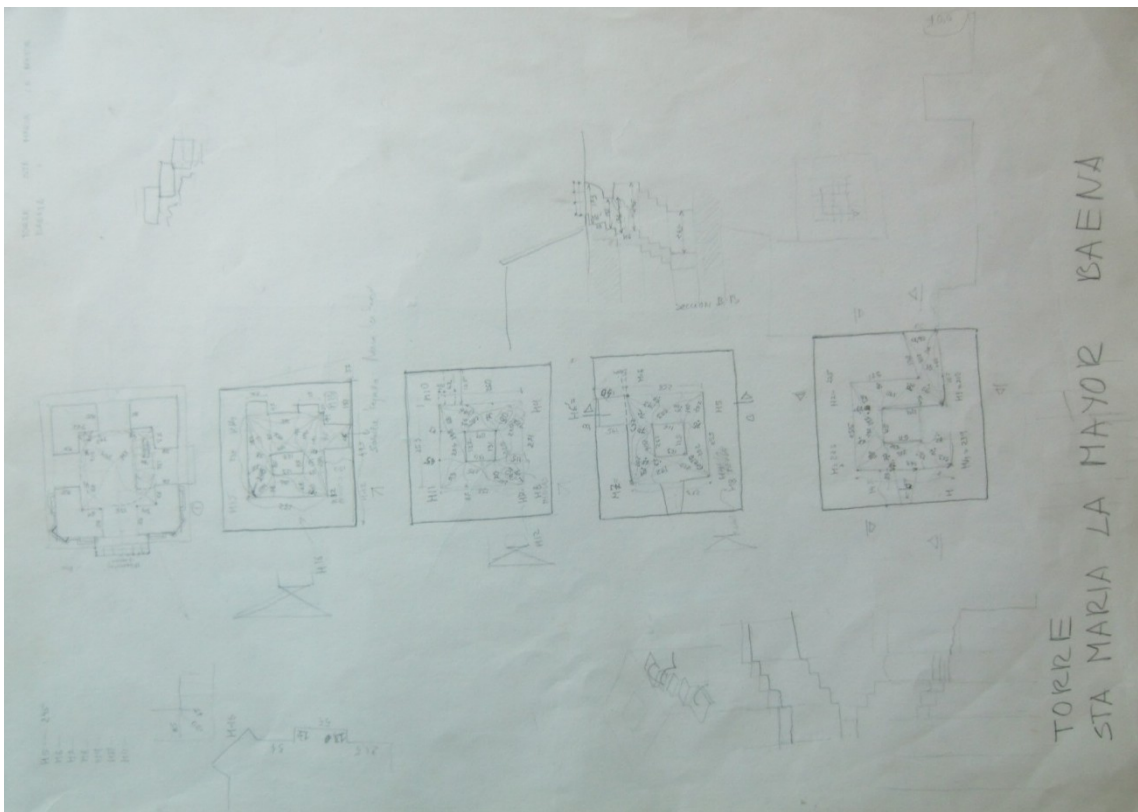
Plantas de la torre - Croquis del levantamiento realizado por el autor
